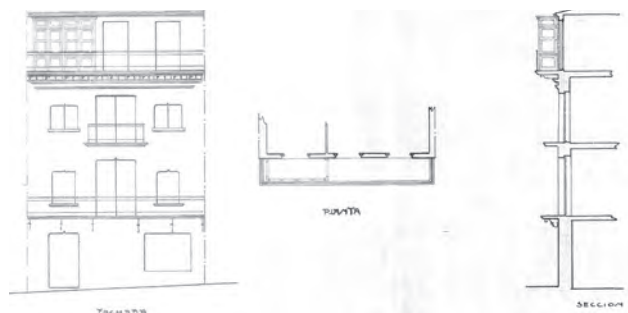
20. 1924 ALZADO PLANTA Y SECCIÓN DE MIRADOR PROPUESTO EN TERCERA PLANTA⁸
